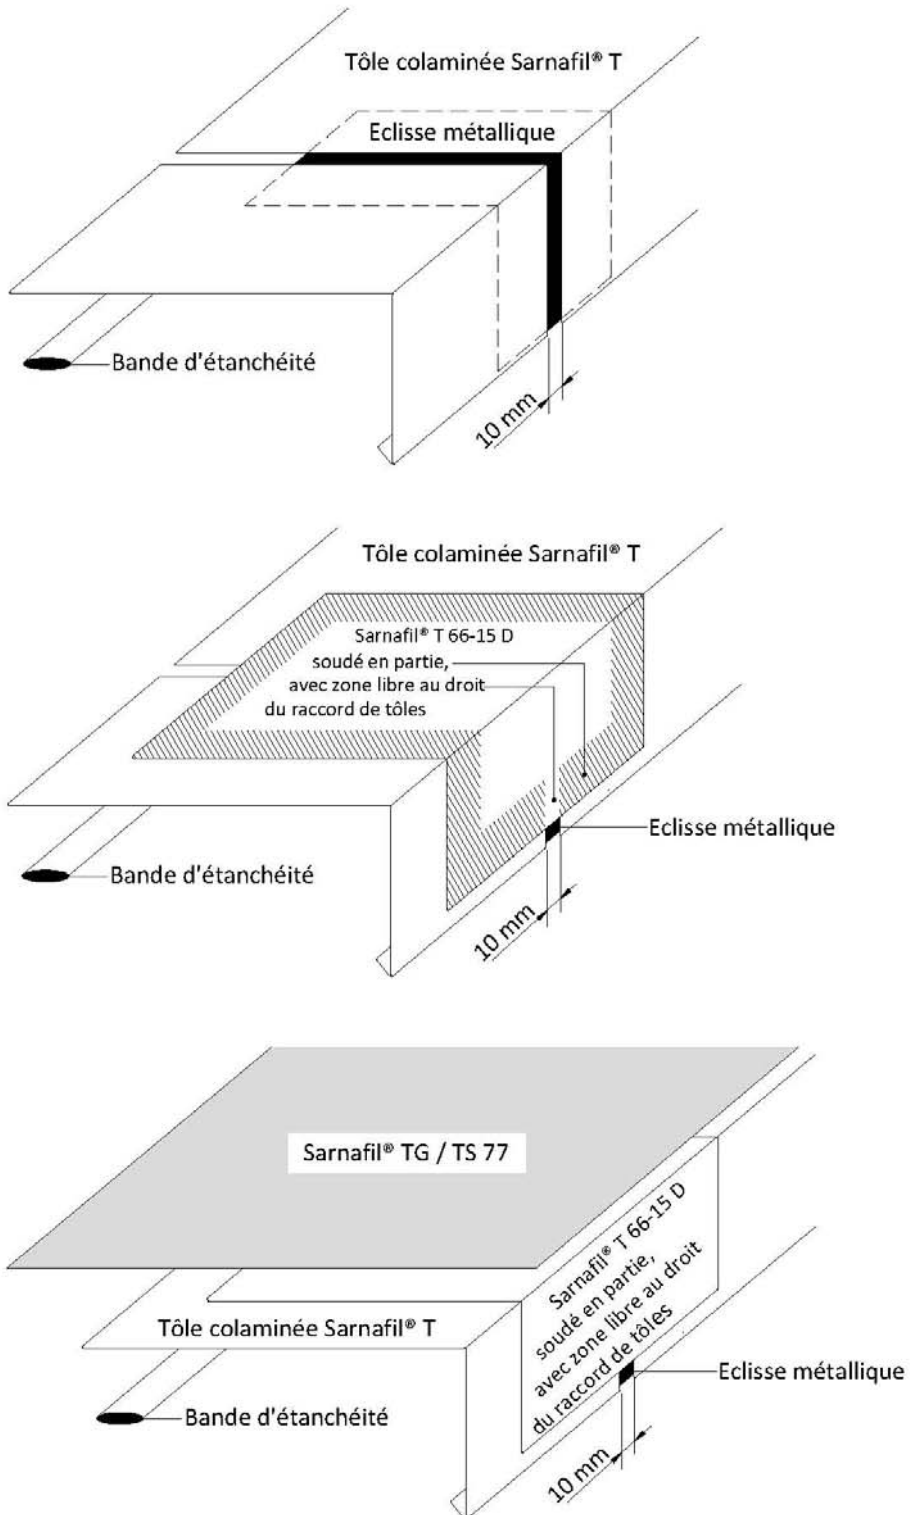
Raccordement des tôles colaminée Sarnafil® T
